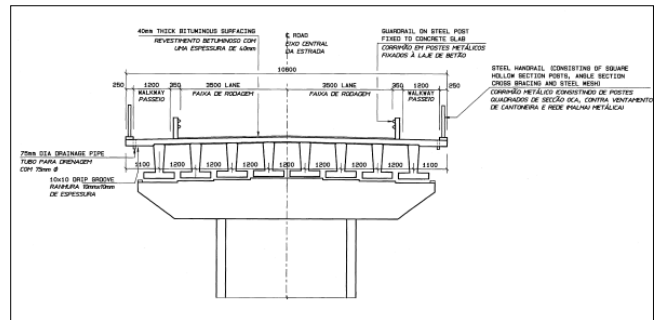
SECÇÃO TRANSVERSAL DO VIADUTO
